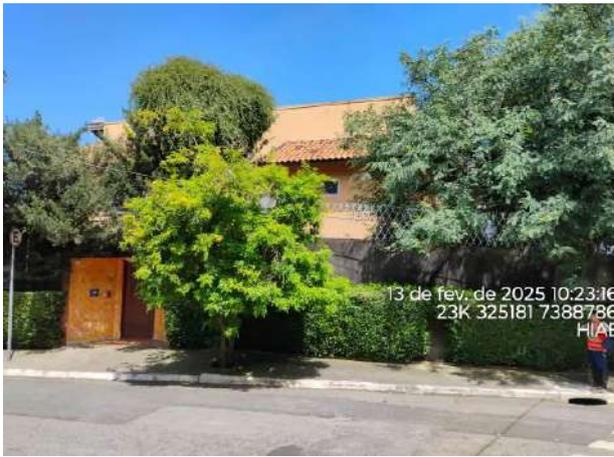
Fachada do imóvel onde está prevista a implantação de ETD.
